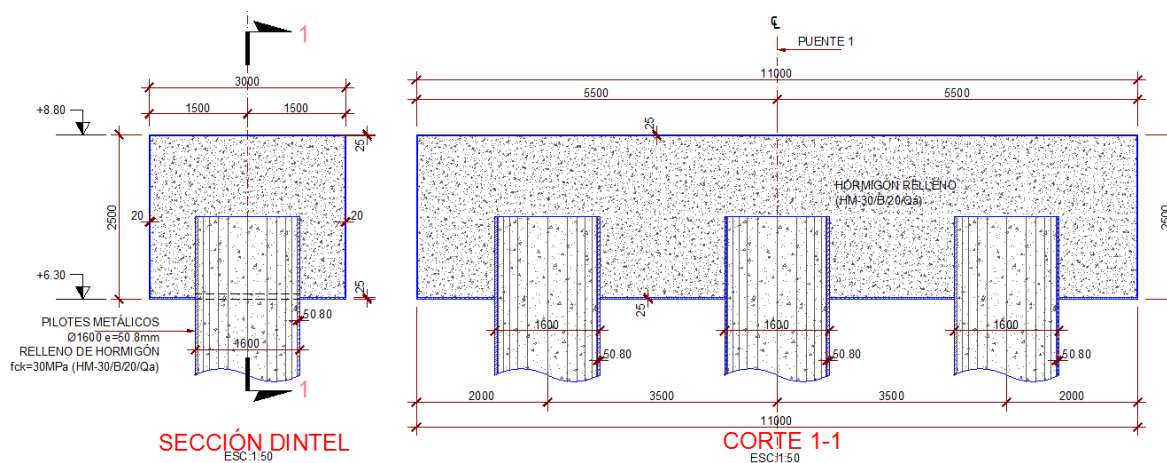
Geometría de las pilas (Fuente: Elaboración propia)
